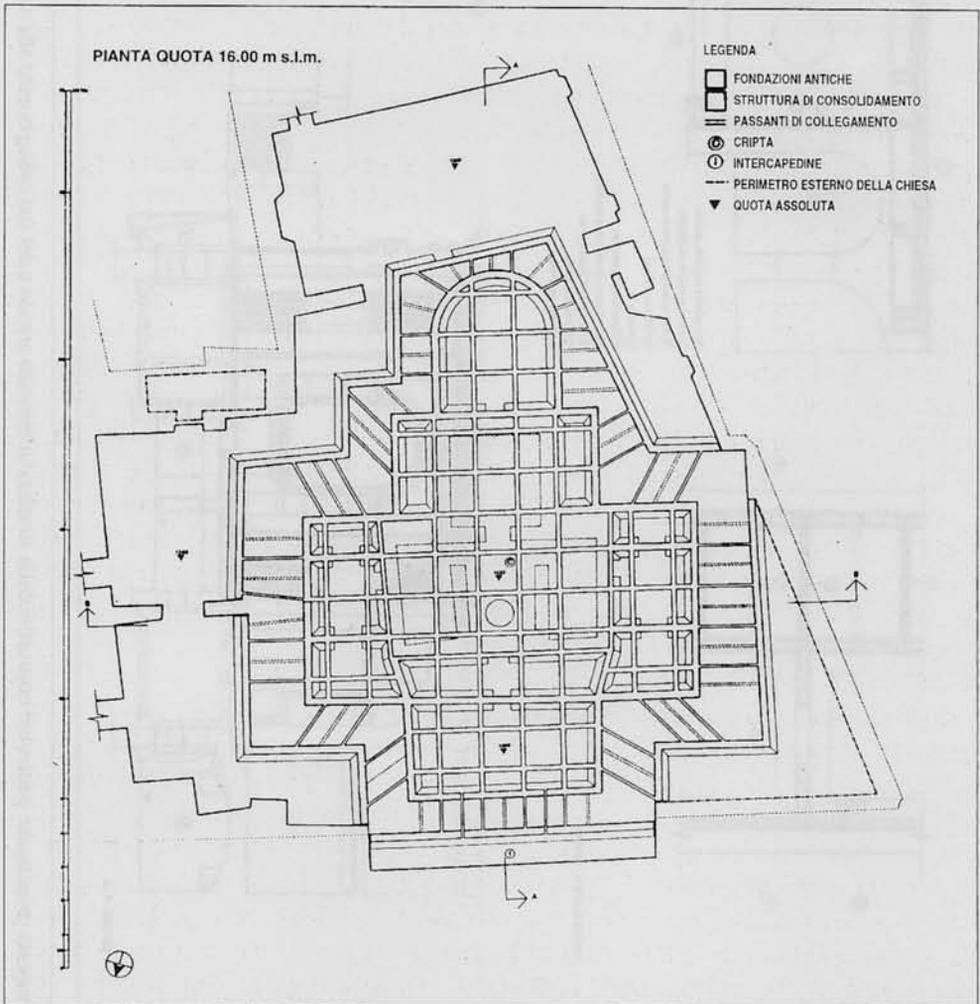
Proposta progettuale: pianta del solaio in cemento armato su cui poggia il pavimento in marmo della chiesa.
